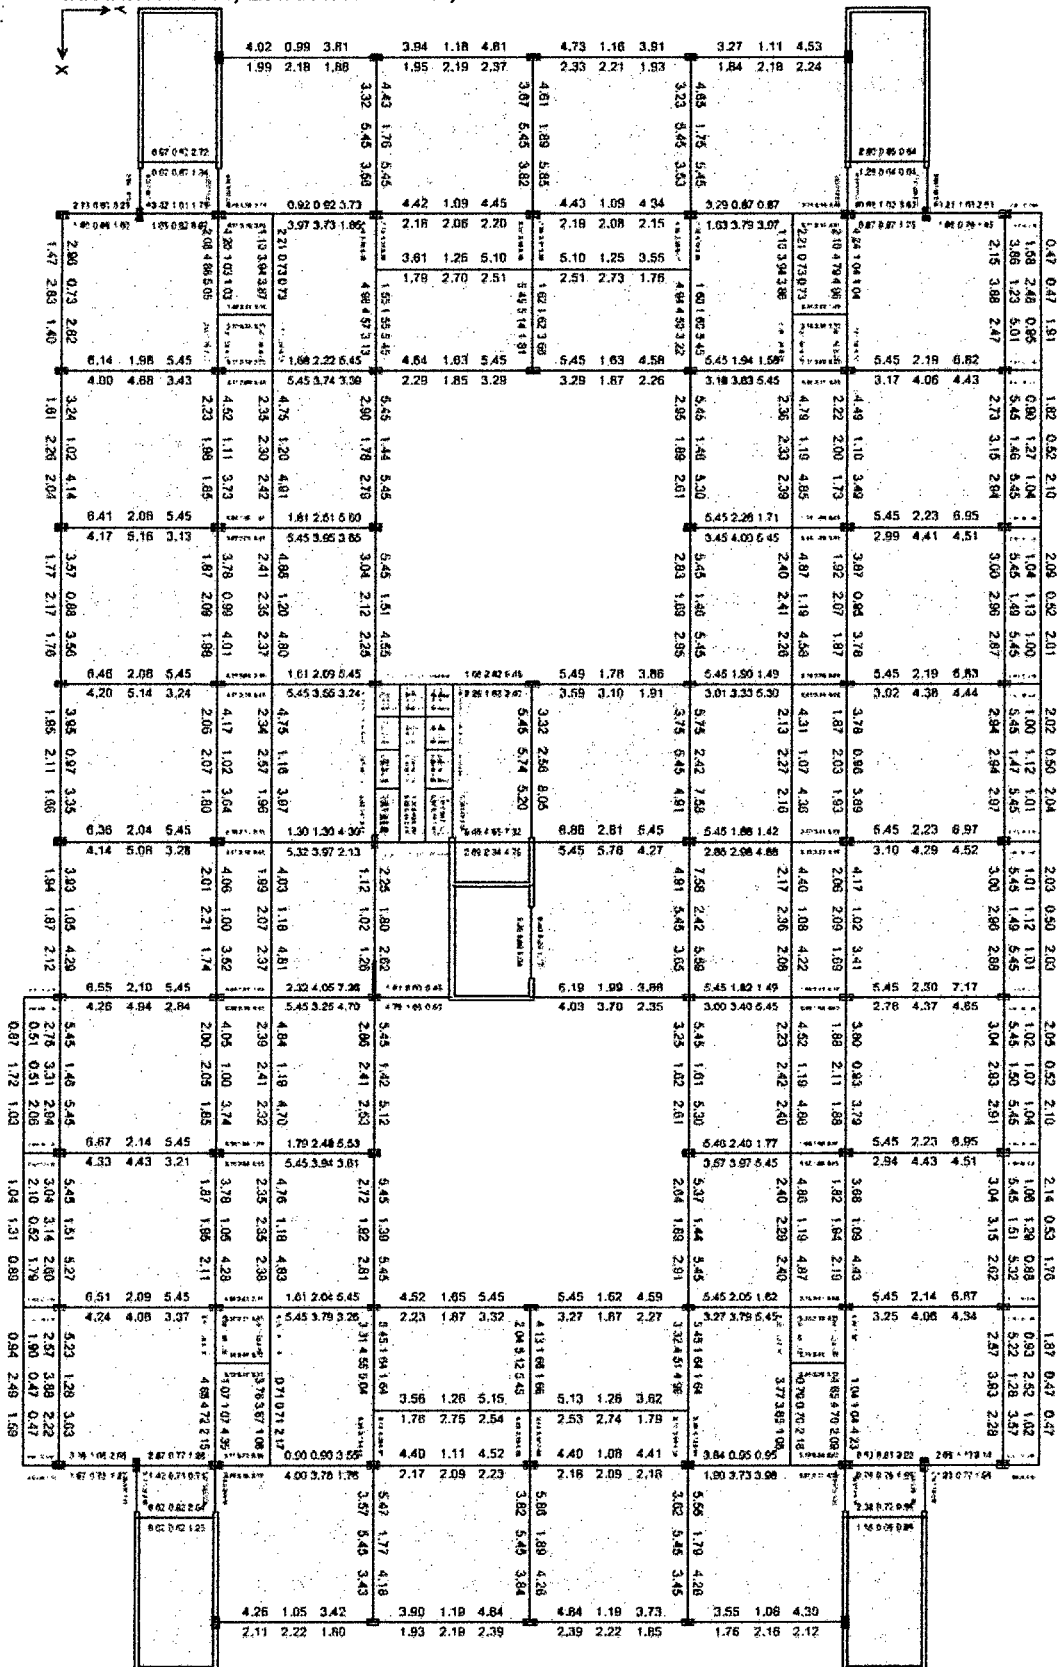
, Estructura aislada, Verificación de elementos estructurales – Piso 4.
